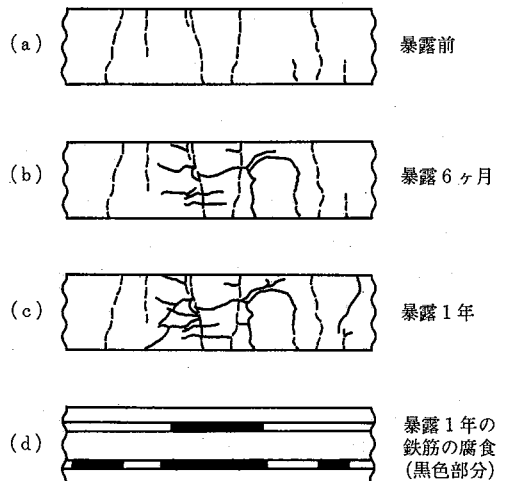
供試体のひびわれ変化および鉄筋の腐食状態
